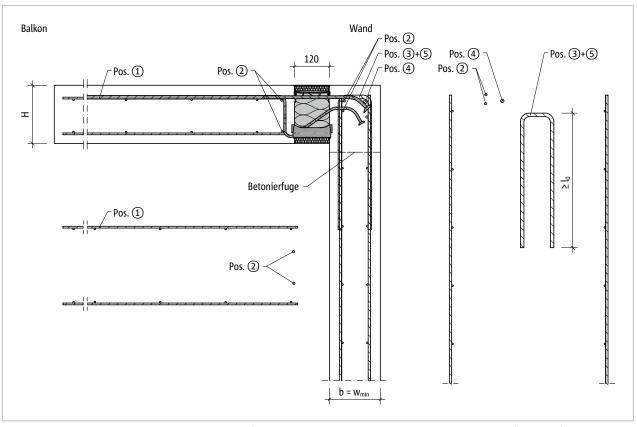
Schöck Isokorb® XT Typ K-O: Bauseitige Bewehrung für Wandanschluss nach unten mit minimaler Bauteilabmessung (w<sub>vorh</sub> = w<sub>min</sub>)
